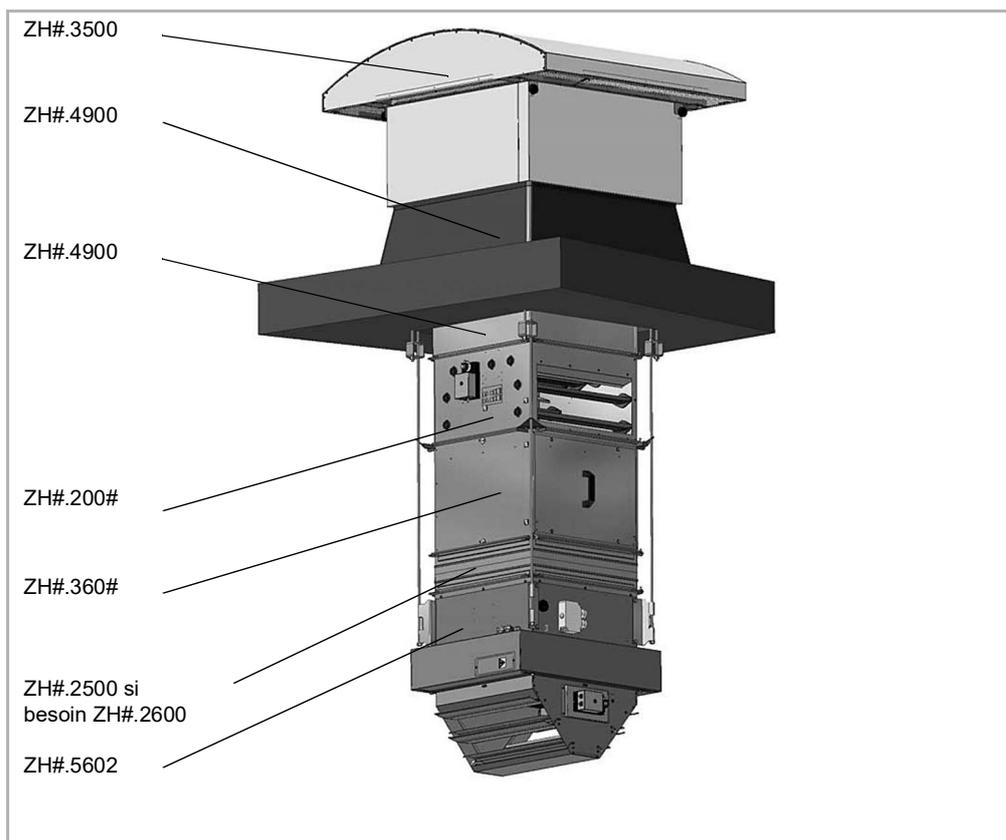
Montage plafonnier d'un appareil de mélange avec accessoires et support plafond (ZHx.5602)
